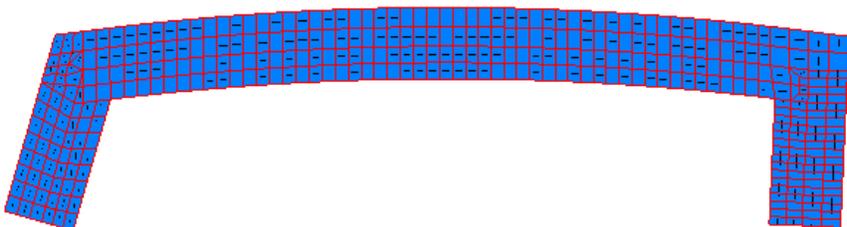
Armatura Platee spalle esistenti di Intradosso direzione 3
